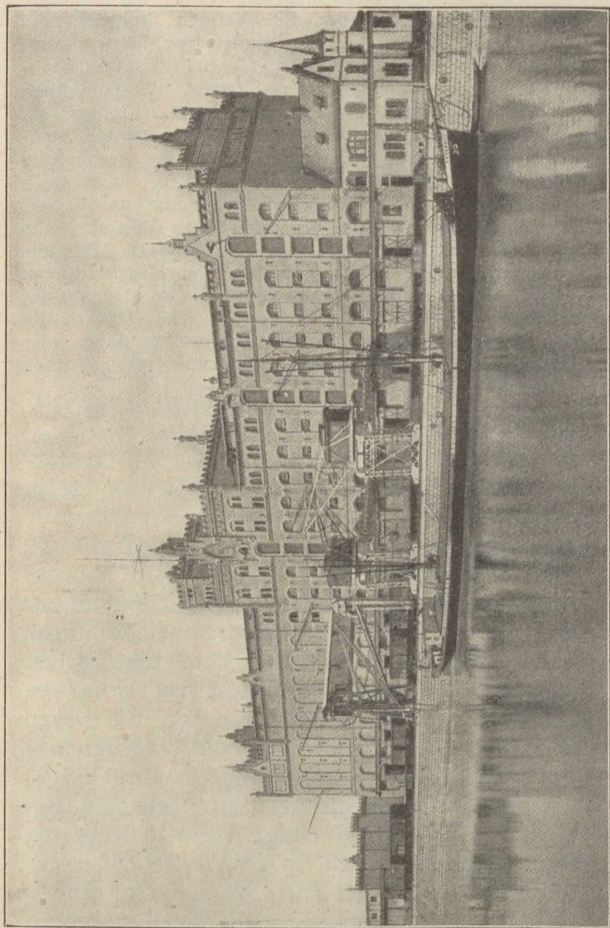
Lagerhaus der Stadt Straßburg i. E., Ansicht mit Ladestraße.
